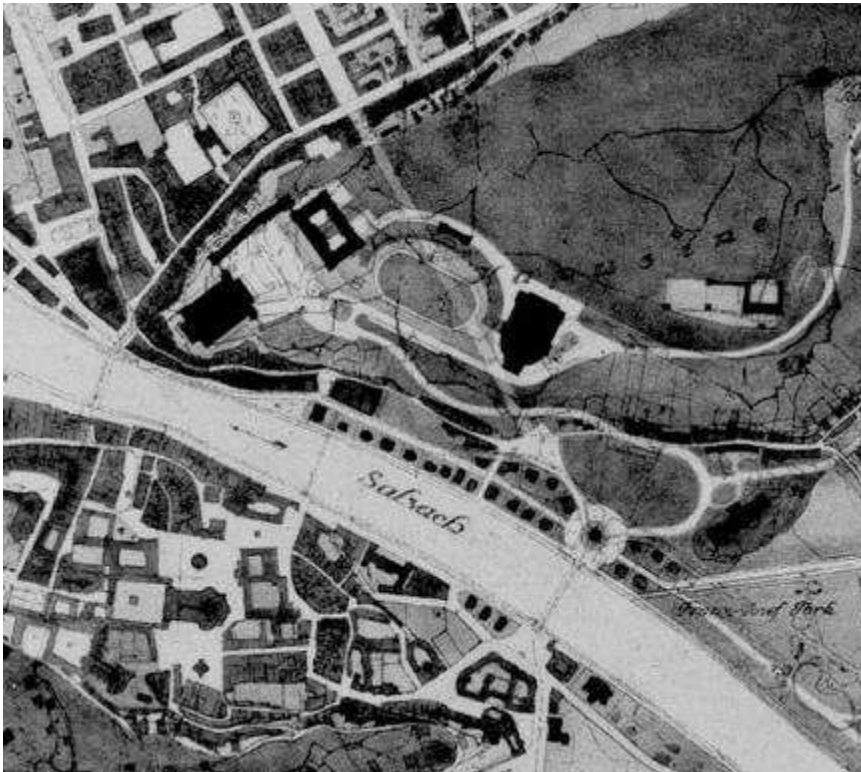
Otto Strohmayer, Ausschnitt, Lageplan, Imbergverbauung, Salzburg, 1943 (Sammlung Fais-Månsson).
